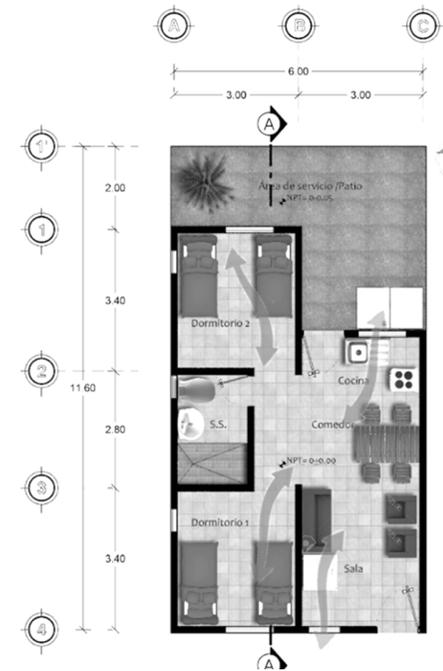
Esquema de planta arquitectónica de vivienda de bloque de concreto.
